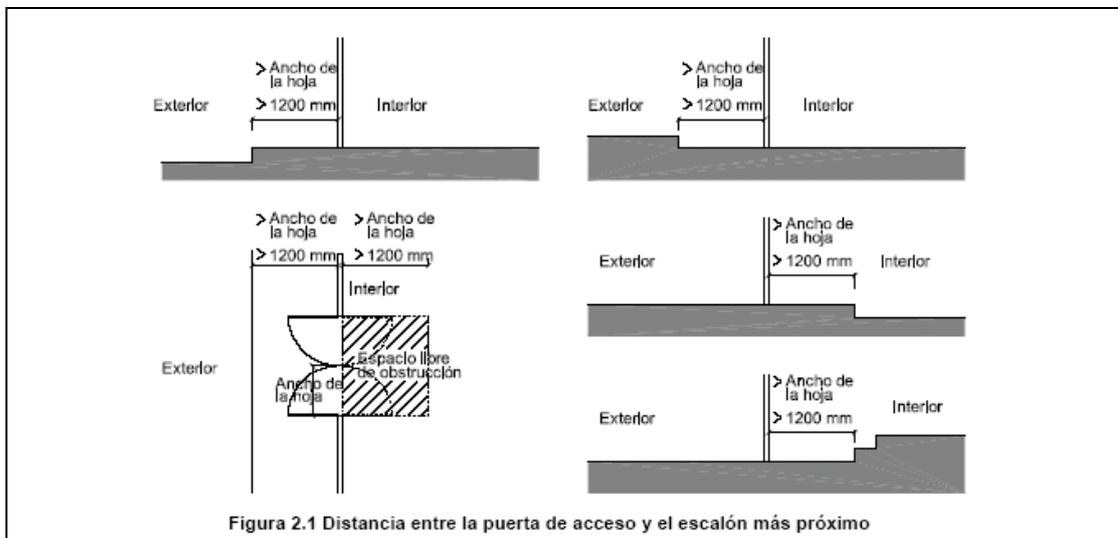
Distancia entre la puerta de acceso y el escalón más próximo
